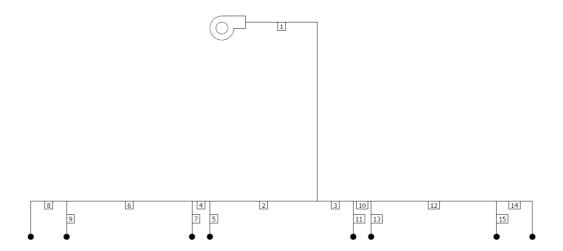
Distribución ramales Planta Baja Cl E-O
